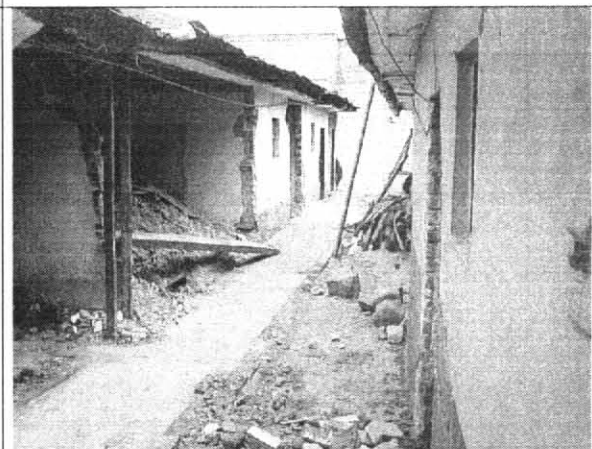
Demoliciones parciales de muros y cubiertas al interior del inmueble
